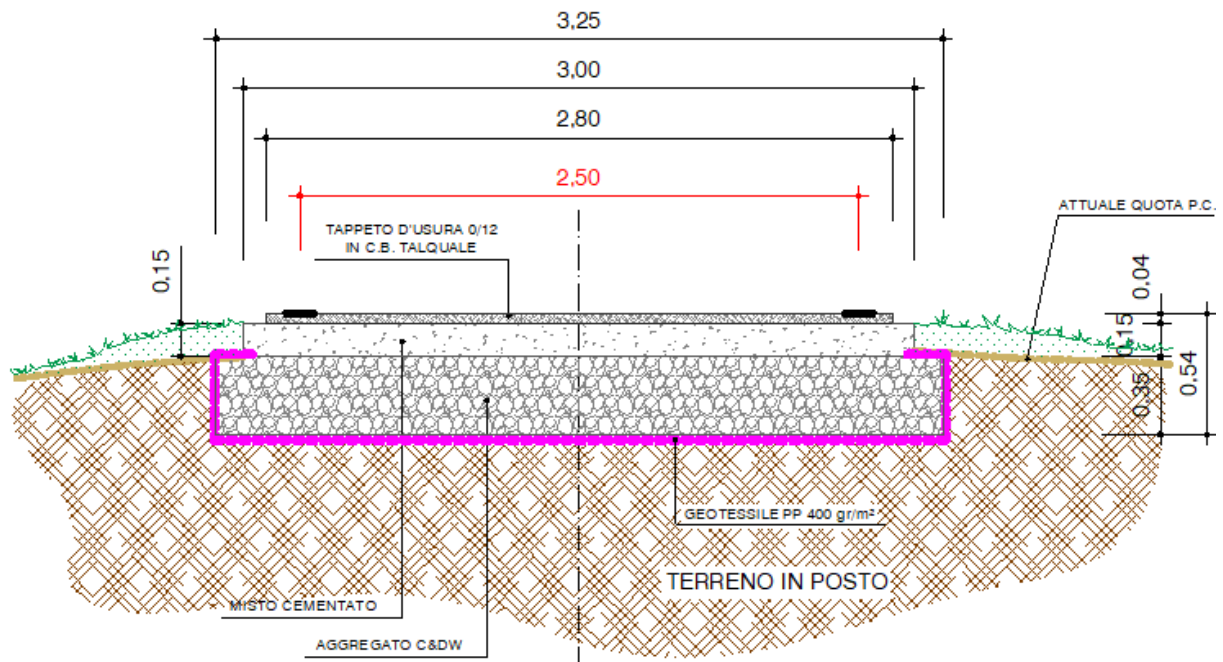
b: Pacchetto sovrastruttura ciclopedonale tipologia "B"
